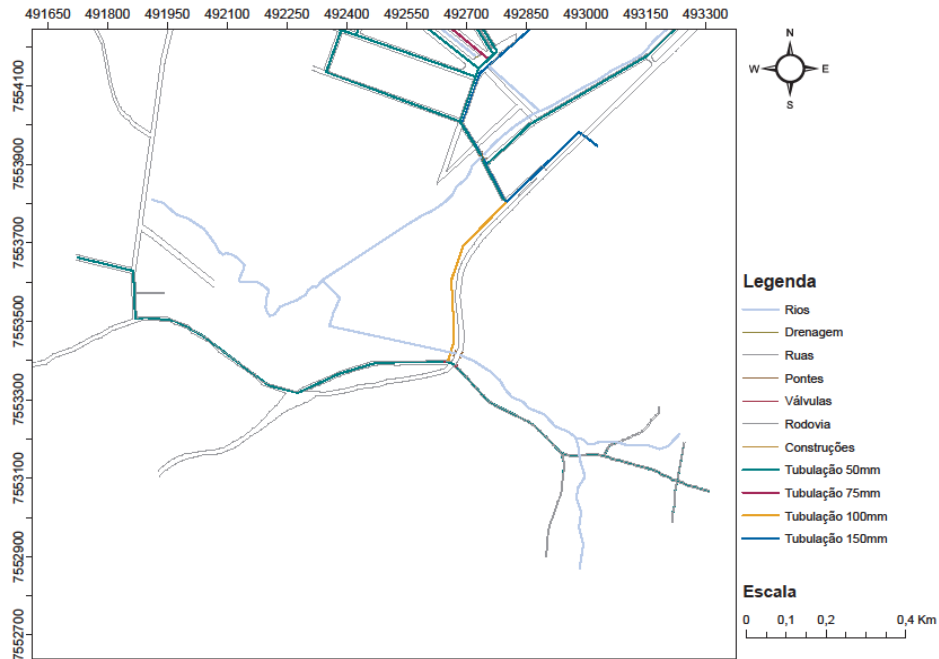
Layout da rede de distribuição do bairro Palmela.
